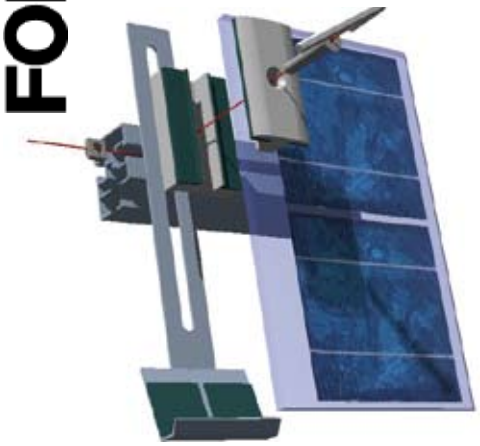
Konstruktionsdetail PV-Fassade: Klemmdetail mit Stützschiene. Foto: ATB-Becker
